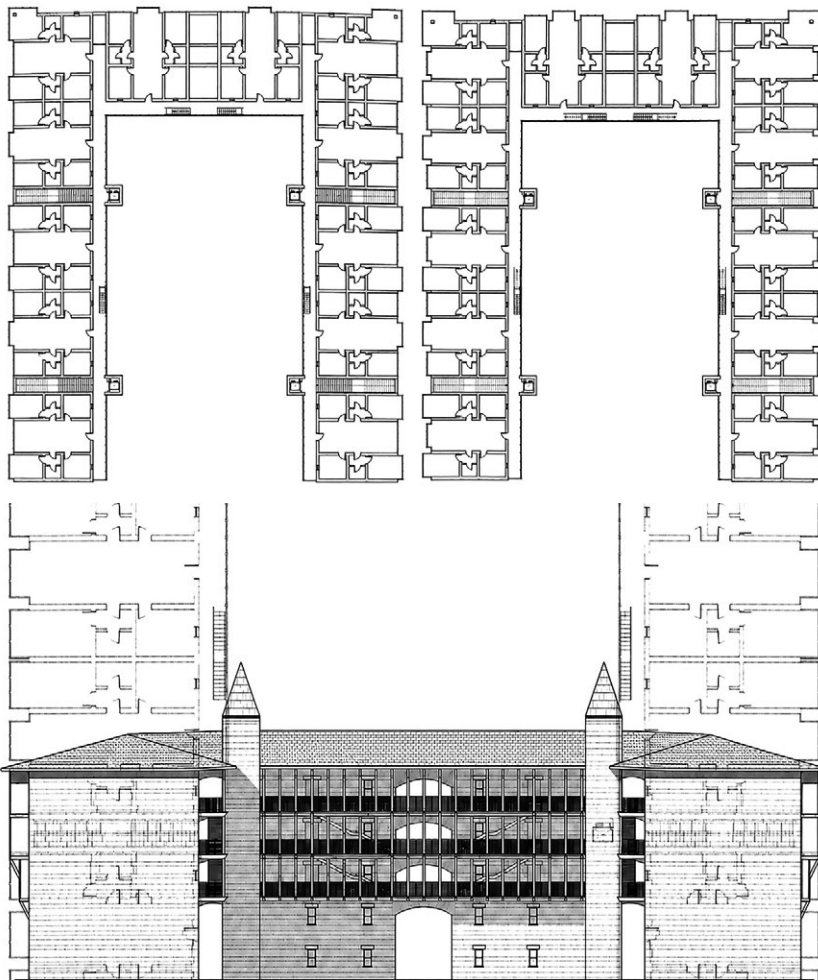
Tipo di casa d'affitto tradizionale su impianto di corte chiusa o semi-aperta: pianta della corte con appartamenti a sofa (sopra), prospetto interno (sotto).
